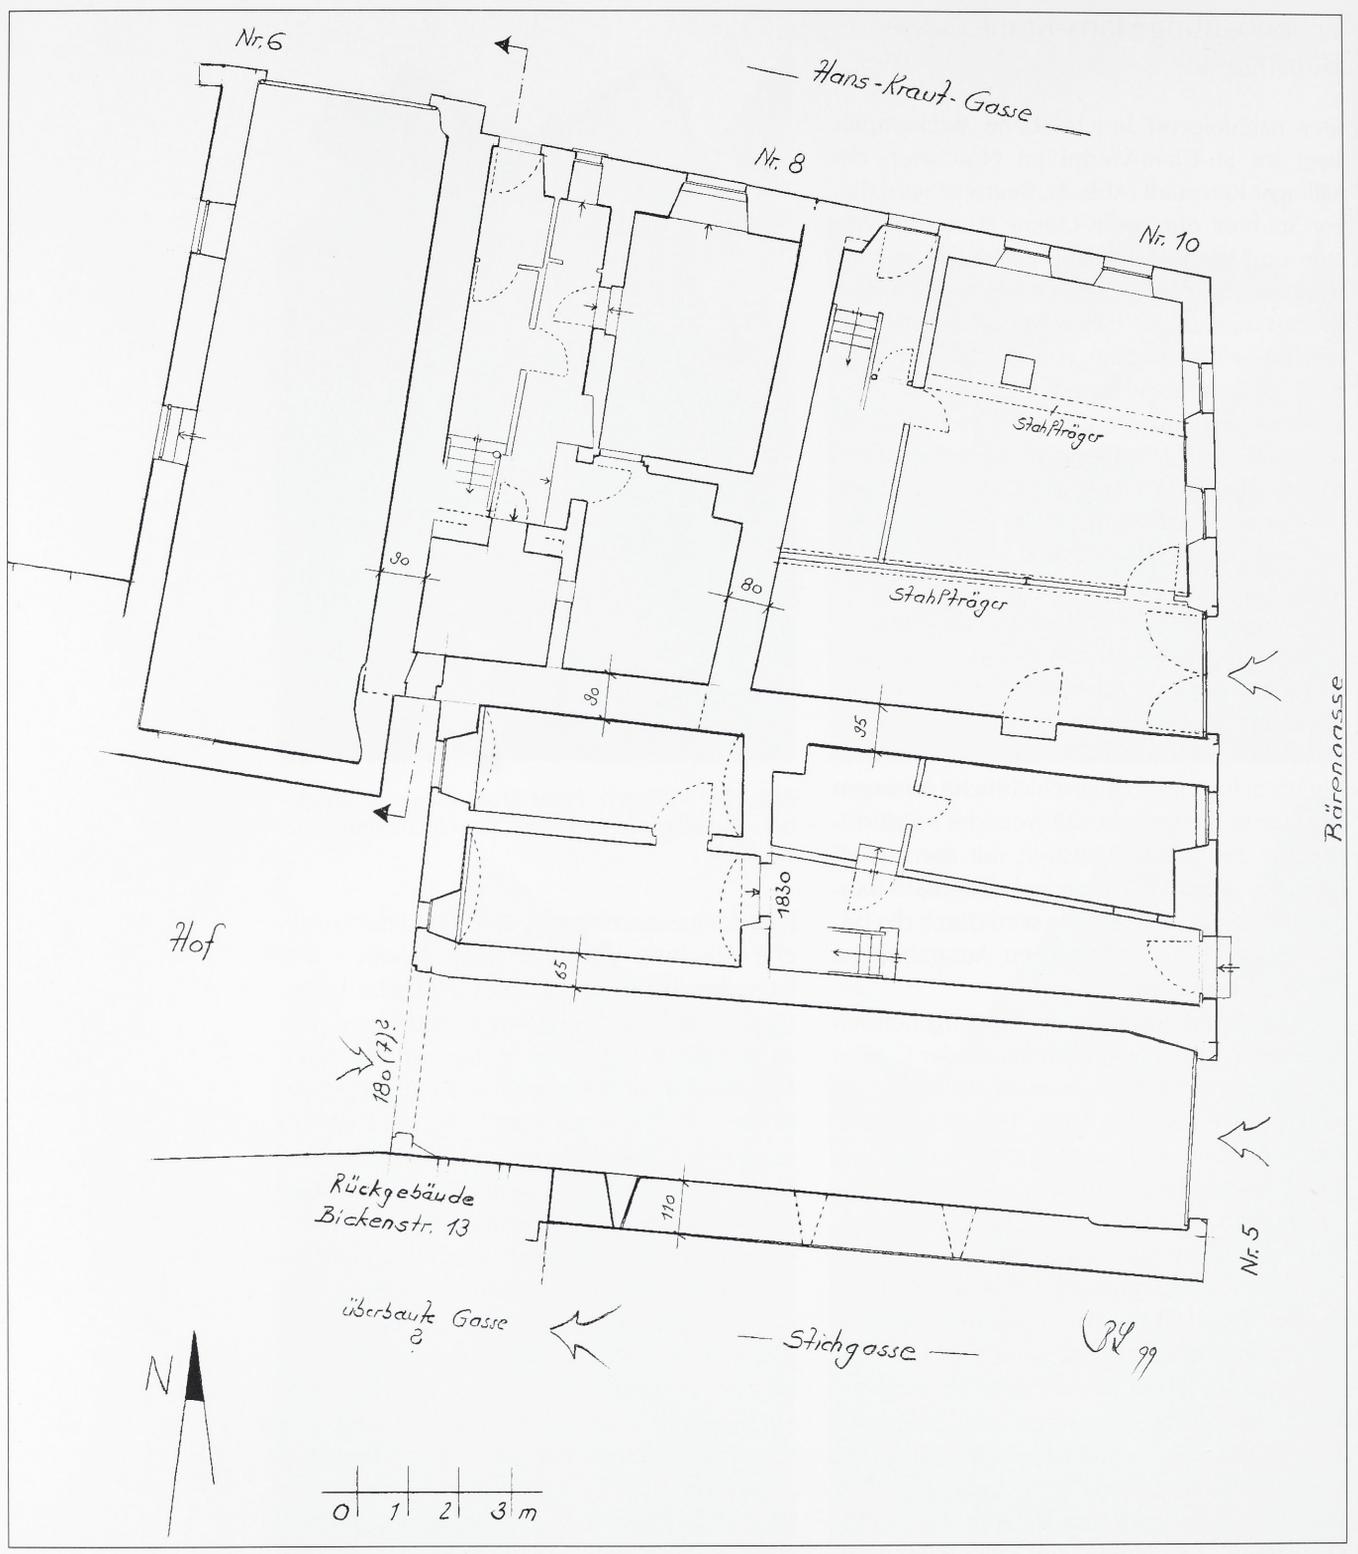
Villingen, Eckbebauung Hans-Kraut-Gasse/Bären-gasse. Grundriß Erdgeschoß, Bestand 1999.
